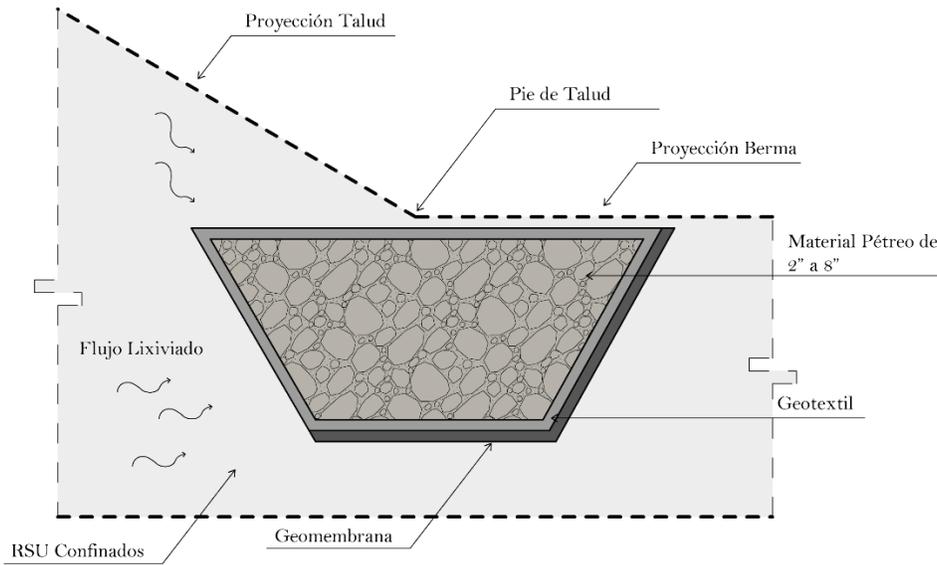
Diagrama de alternativa de dren perimetral en talud intermedio recubierto con geomembrana para la captación de lixiviado a pie de talud
